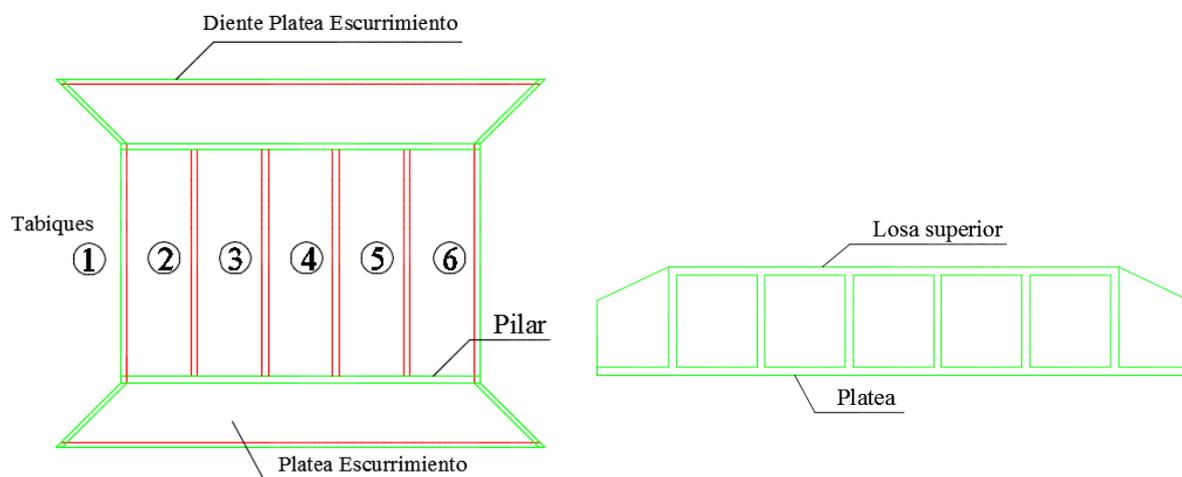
Elementos estructurales estudiados en Alcantarilla SE
